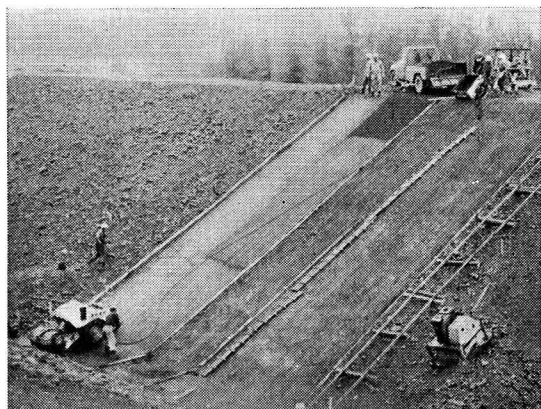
第2号開きよアスファルト・コンクリート試験舗設状況
